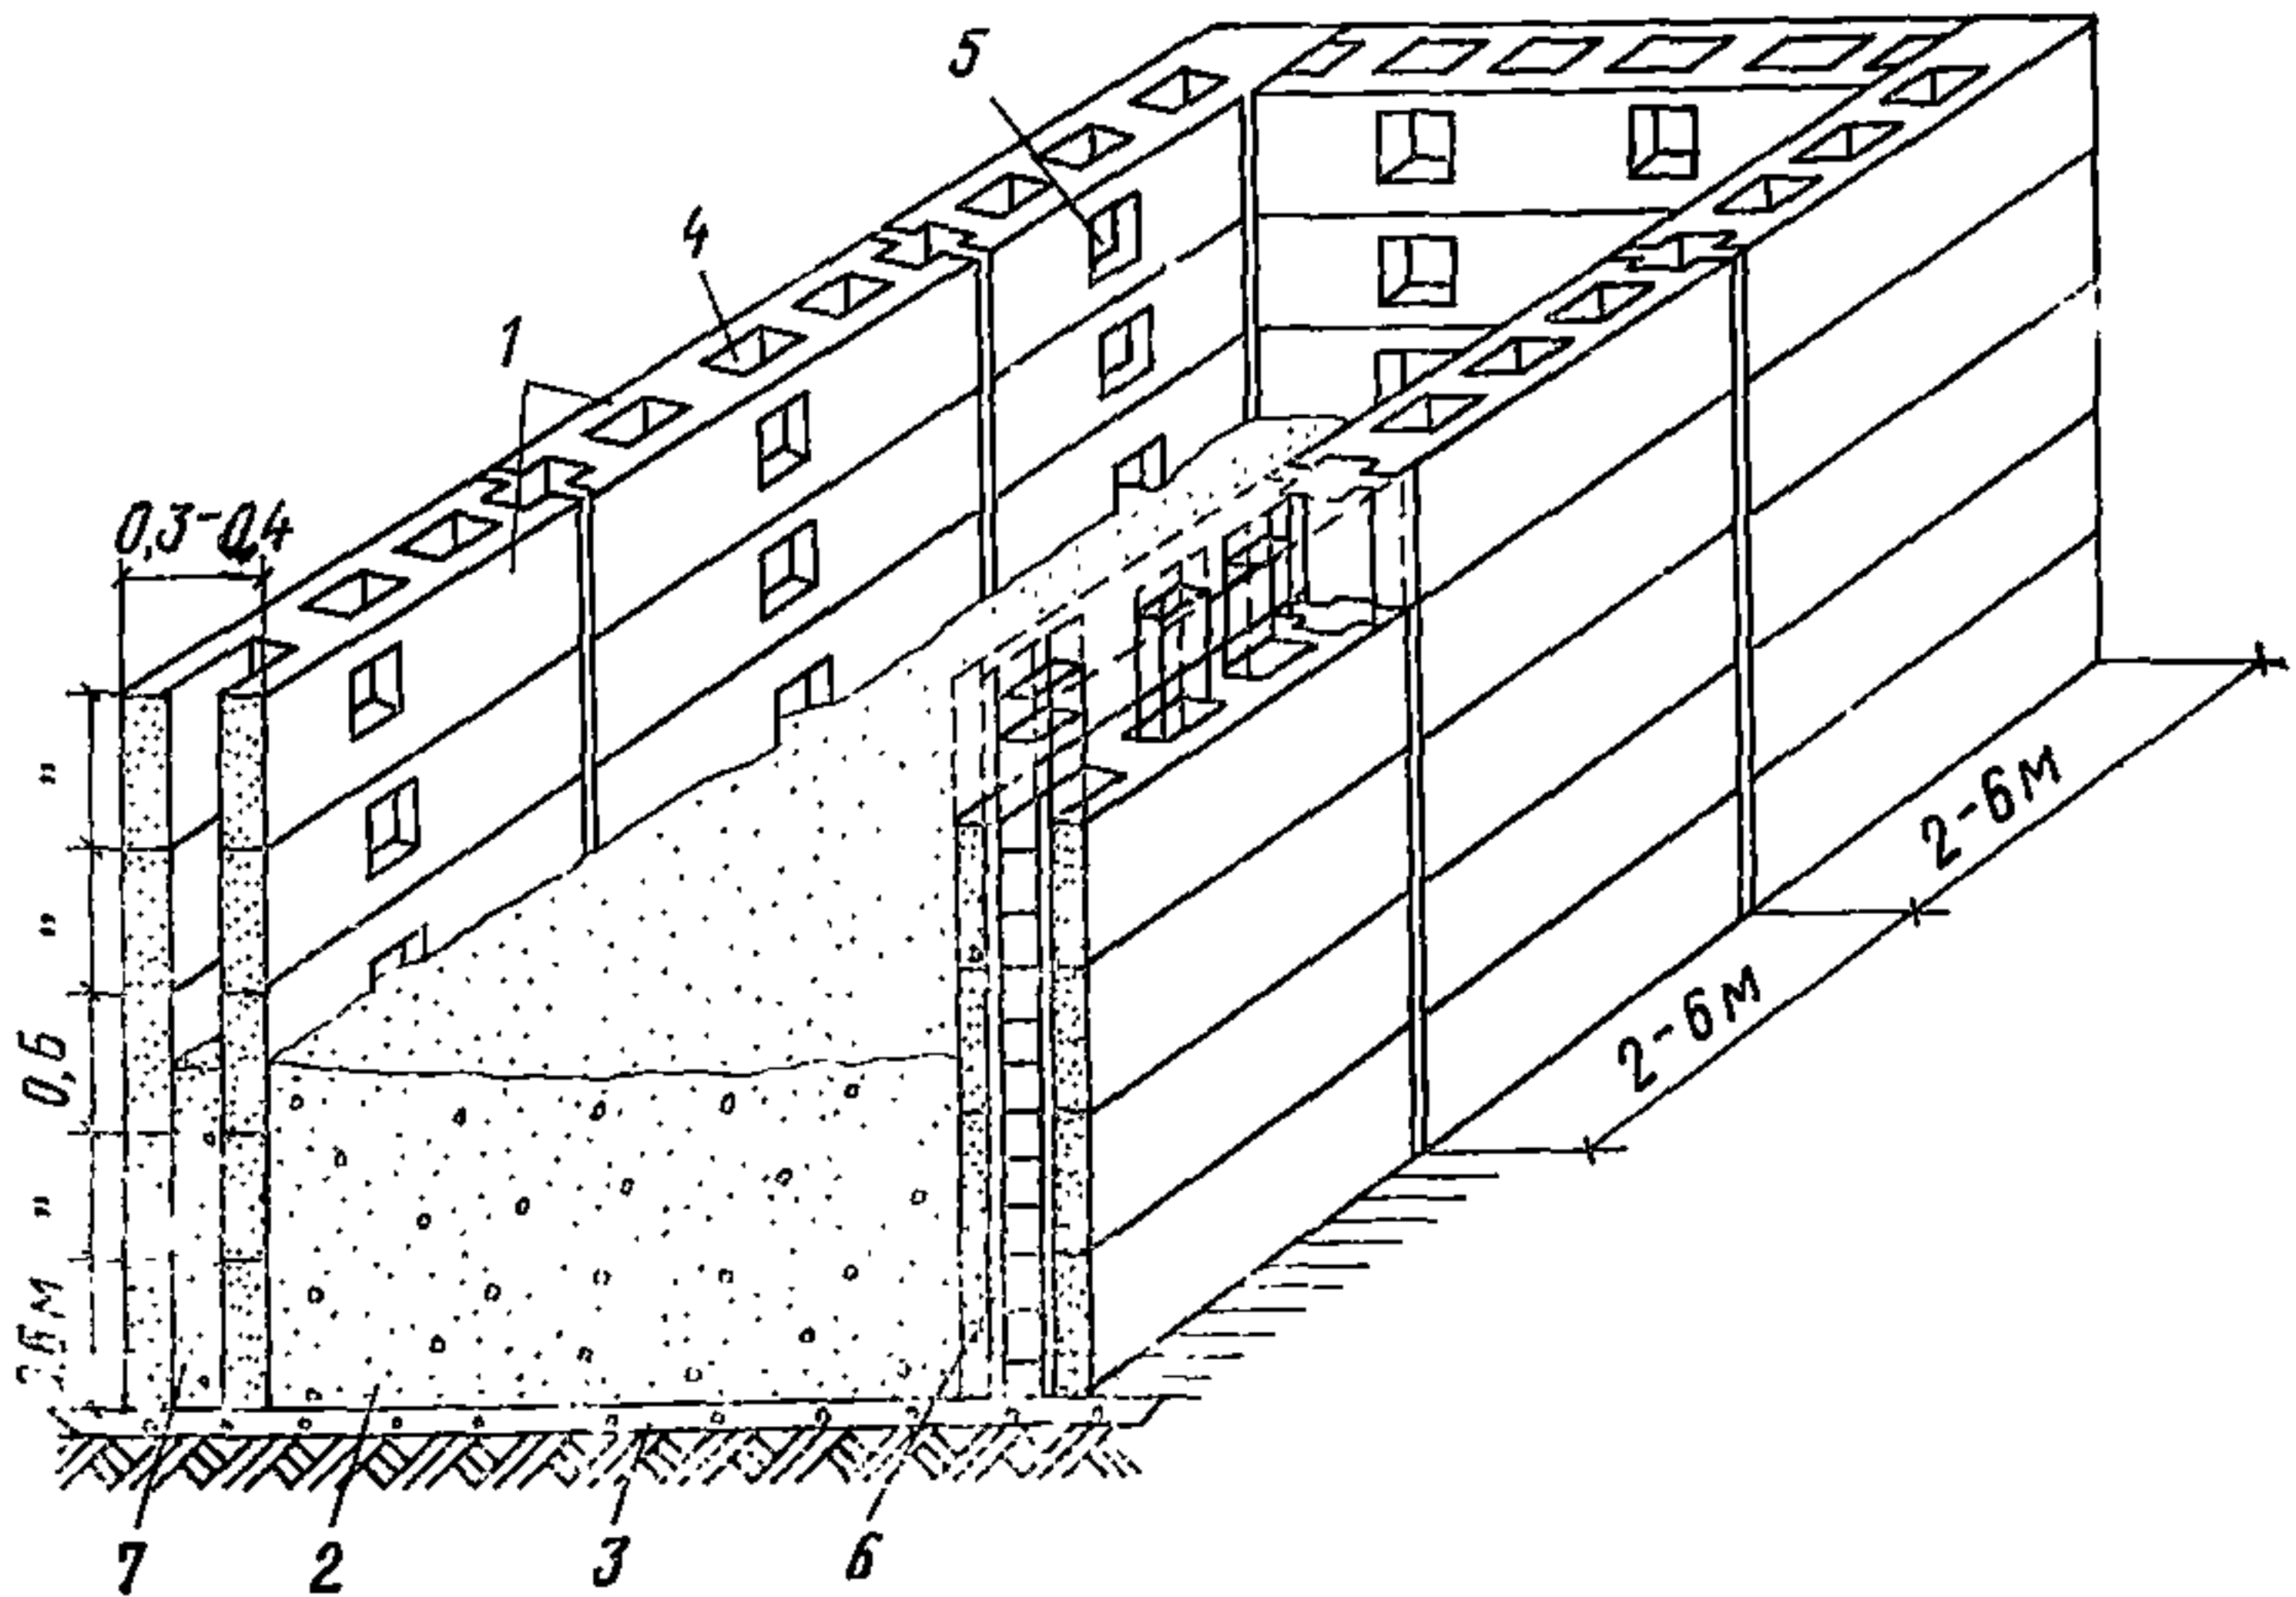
Фрагмент несъемной опалубки массивного фундамента из блоков УДБ
